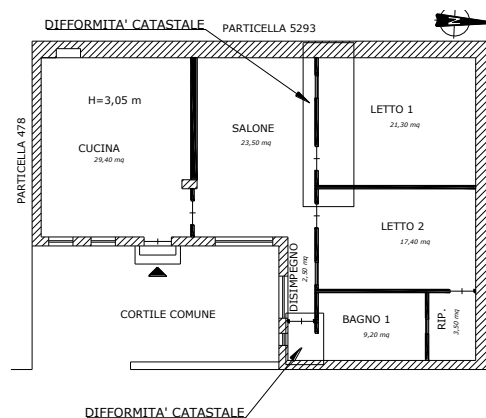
Planimetria delle difformità catastali dell'appartamento al piano terra
